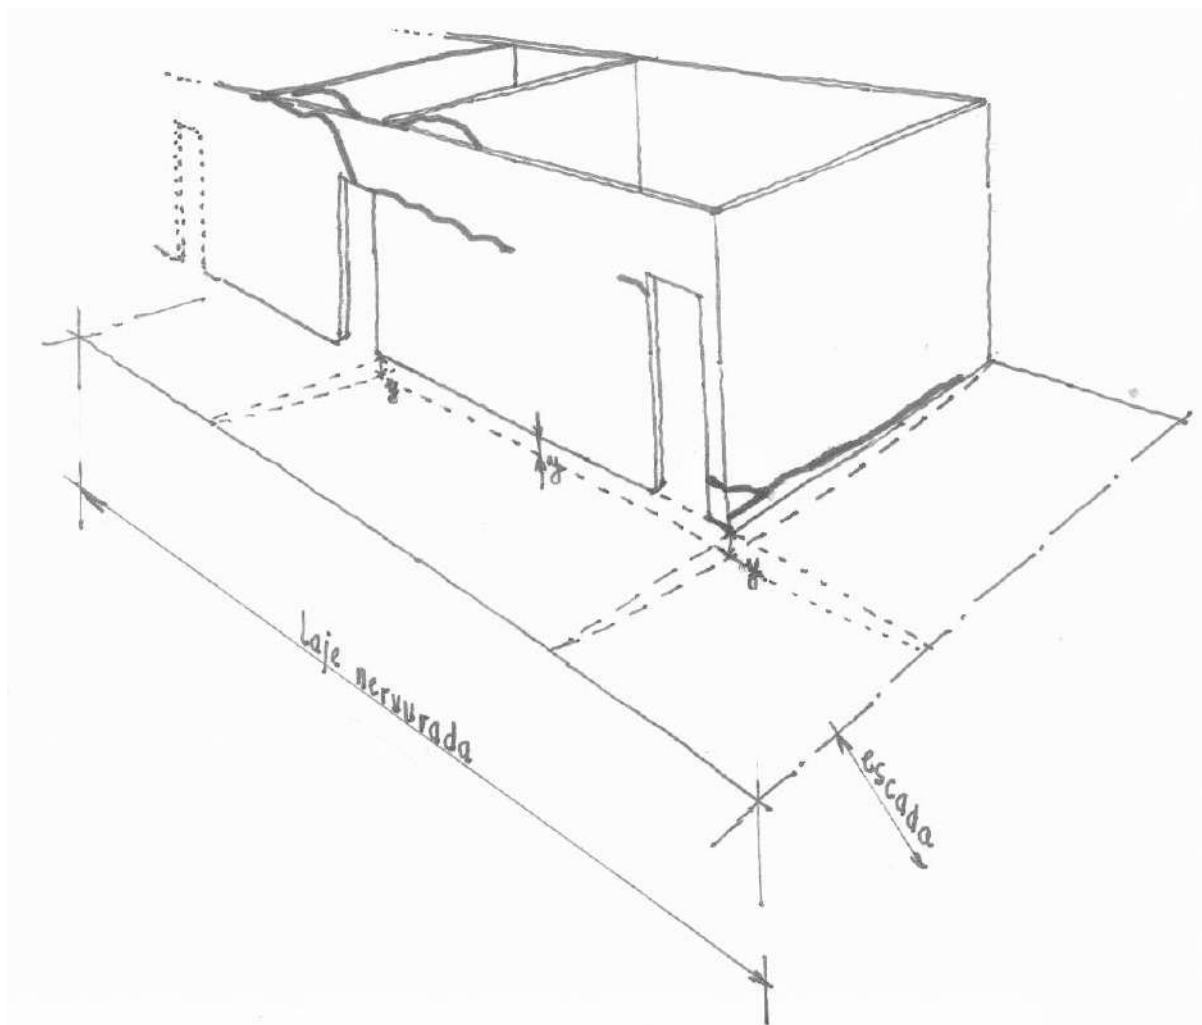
Trincas nas paredes frontais do pavimento superior do Fórum de Juazeiro, BA.
